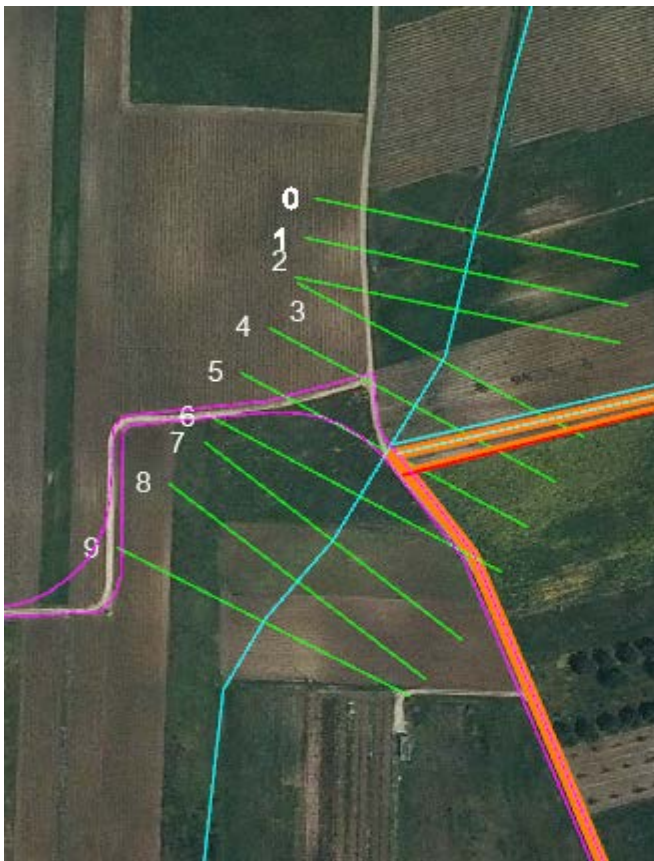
Planimetria con indicazione delle sezioni su Hec-Ras.
